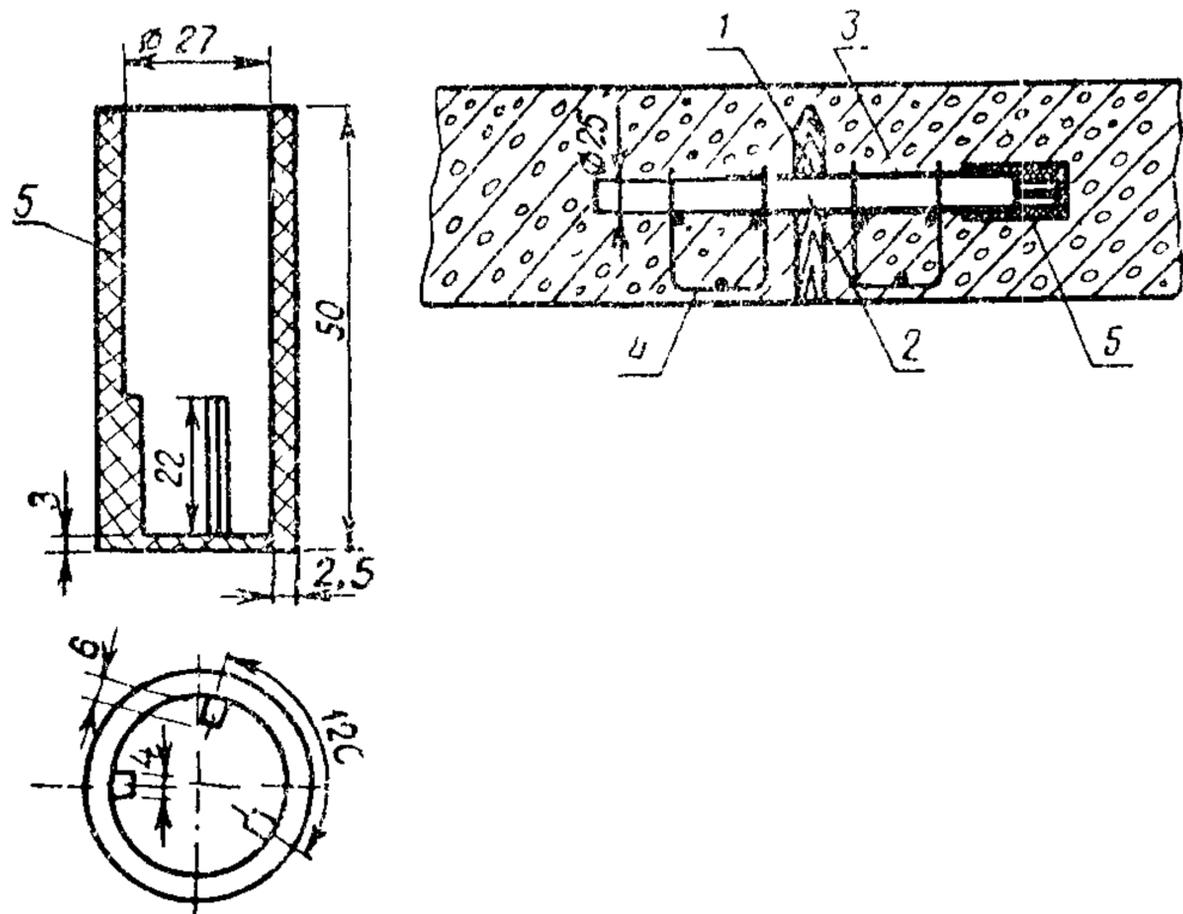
Схема установки стального стержня с резиновым колпачком в цементобетонное покрытие.
